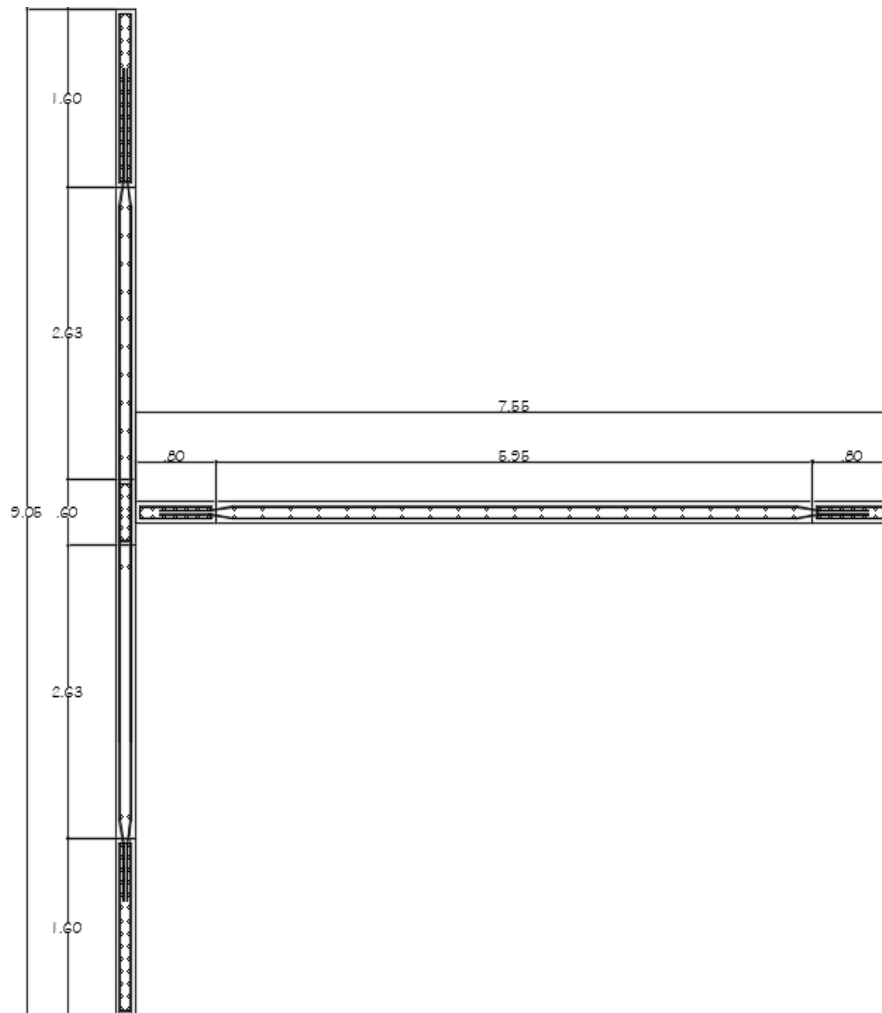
Detalle del refuerzo de los muros, PIER 7A y PIER A. Extraída de ETABS.
